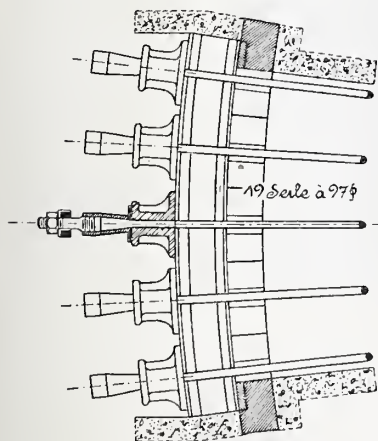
Kabelverankerung. Grundriss. — 1:100.
